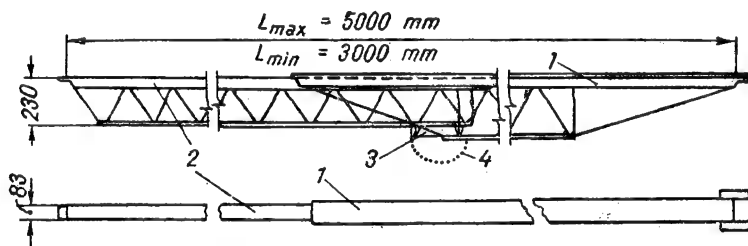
Grindă extensibilă de 3,00—5,00 m :
